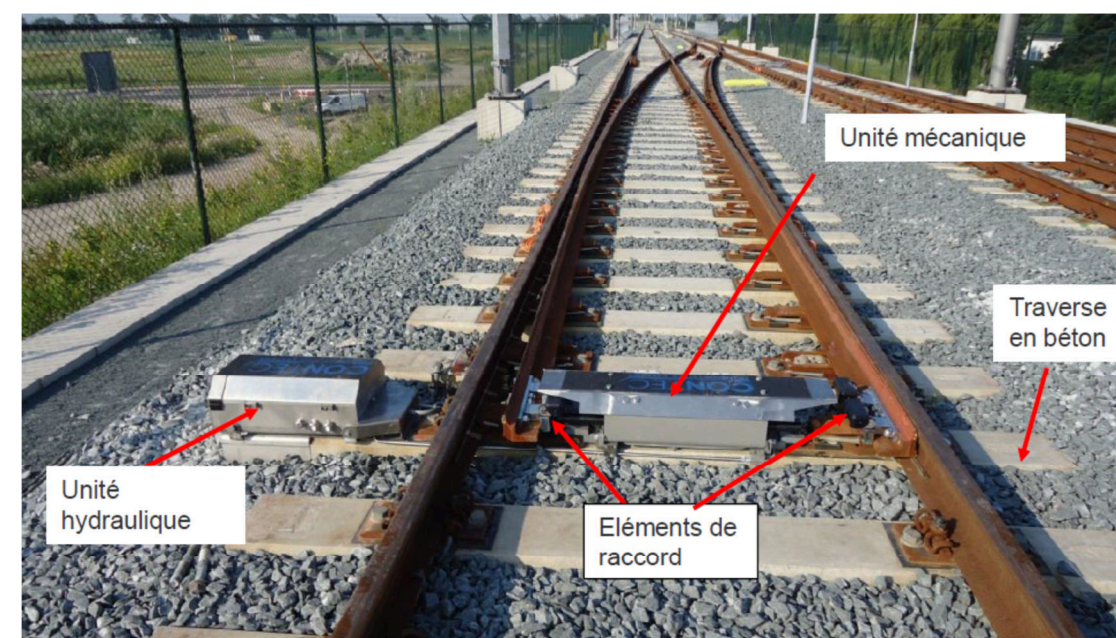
Exemple d'une installation moteur entre rails en aérien
